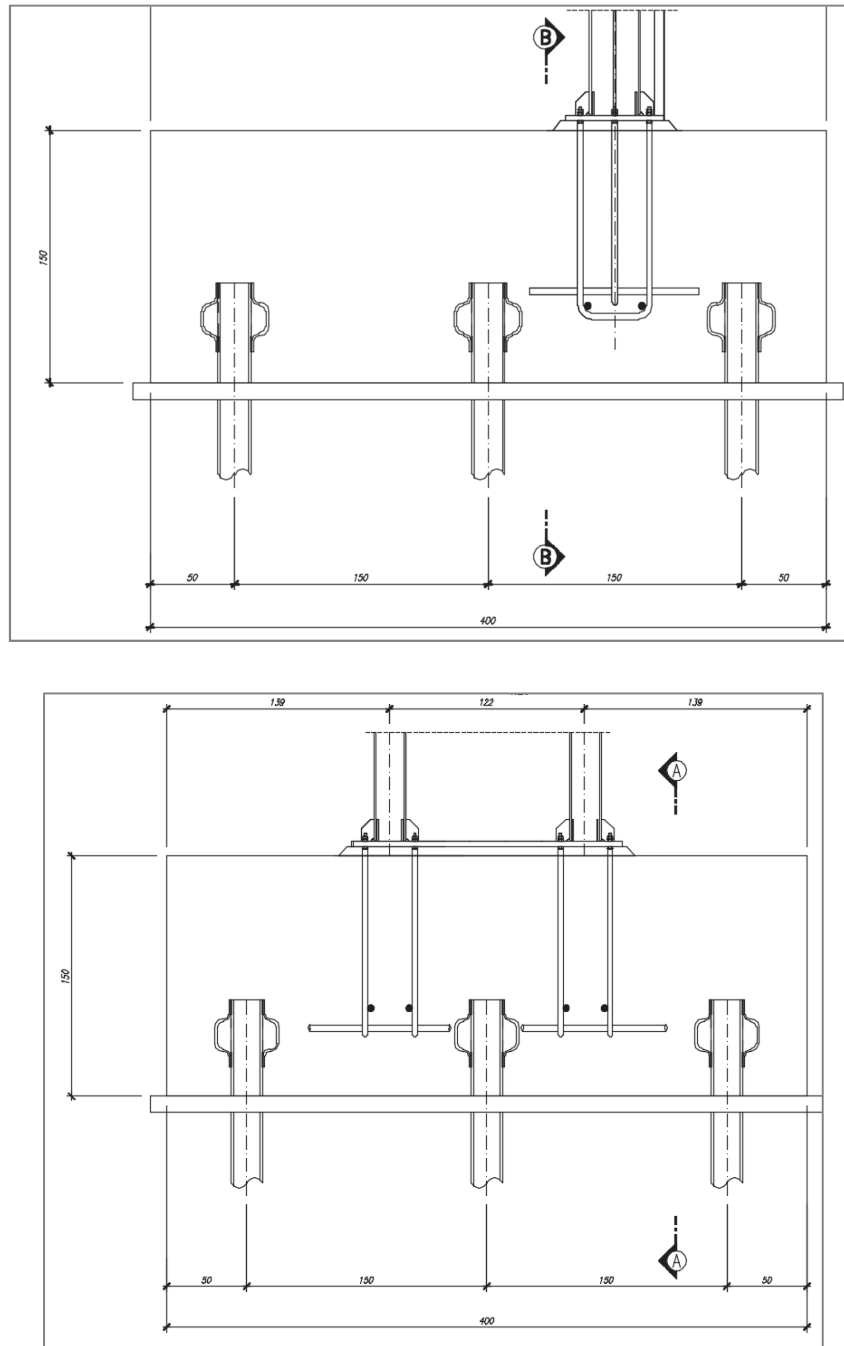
carpenteria delle fondazioni Sezione trasversale e longitudinale
